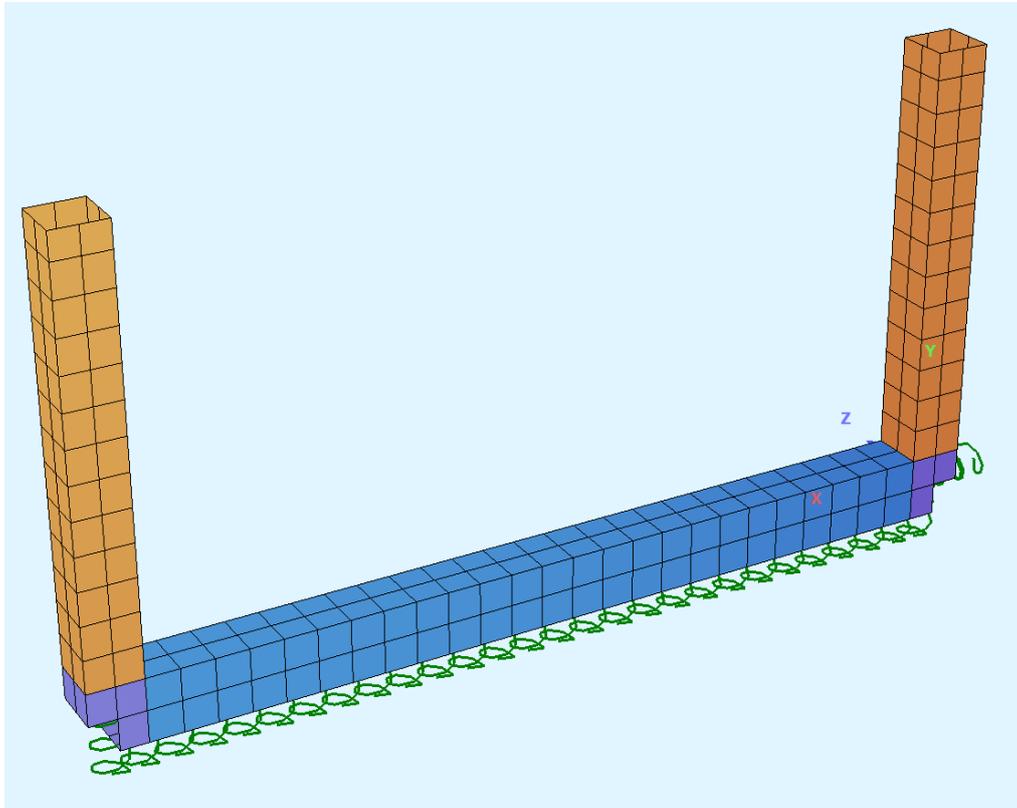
Sezione trasversale muro ad U –vista 3D
